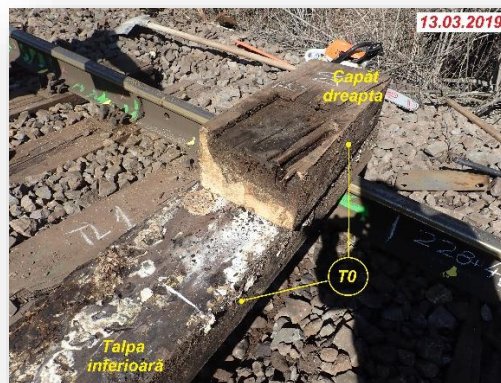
Traversa T_0 în secțiunea de capăt din dreapta
